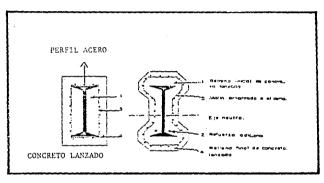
PROTECCION ESTRUCTURAS DE ACERO.
